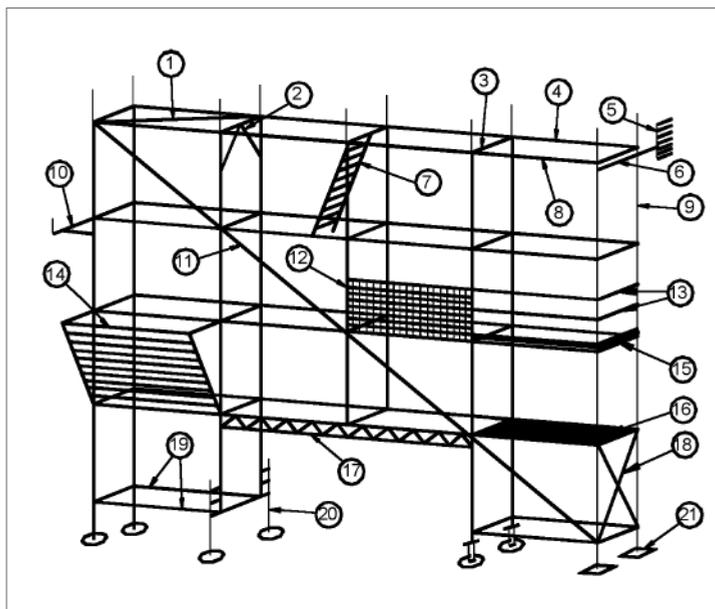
Nomenclatura degli elementi principali di un ponteggio: 1 diagonale in pianta, 2 archetto di rinforzo telaio, 3 collegamento trasversale, 4 corrente posteriore, 5 ancoraggio, 6 collegamento, 7 scaletta, 8 traverso, 9 montante, 10 apparecchio sollevatore, 11 diagonale di facciata, 12 graticcio di protezione, 13 doppio parapetto, 14 mantovana o parasassi, 15 fermapiede, 16 impalcato, 17 trave passo-carraio, 18 rinforzo al primo livello, 19 rinforzo alla base, 20 pezzo speciale, 21 basetta fissa o regolabile.
